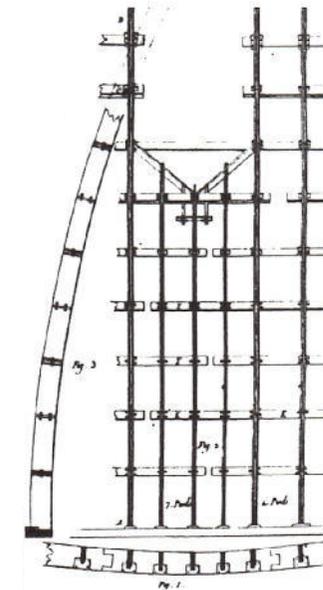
Halle au blé, Paris, Konstruktionsdetail
